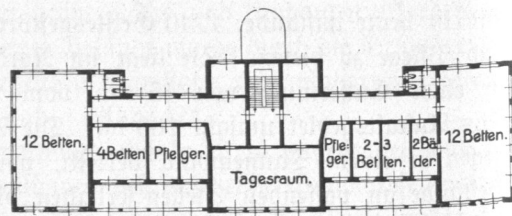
Irrenanstalt Friedrichsberg, Krankengebäude, Obergeschoss, Grundriß.
